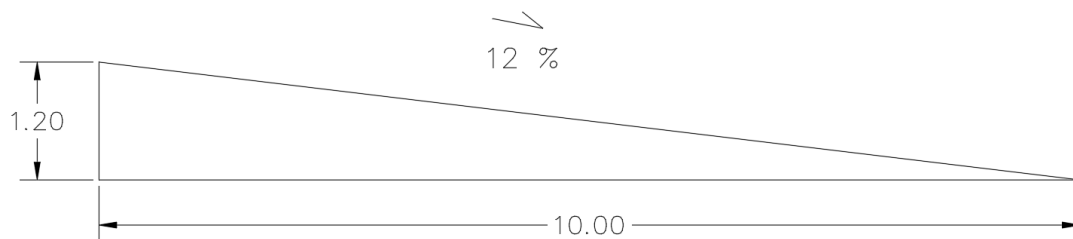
2 Sección longitudinal de primer tramo en vía de acceso
